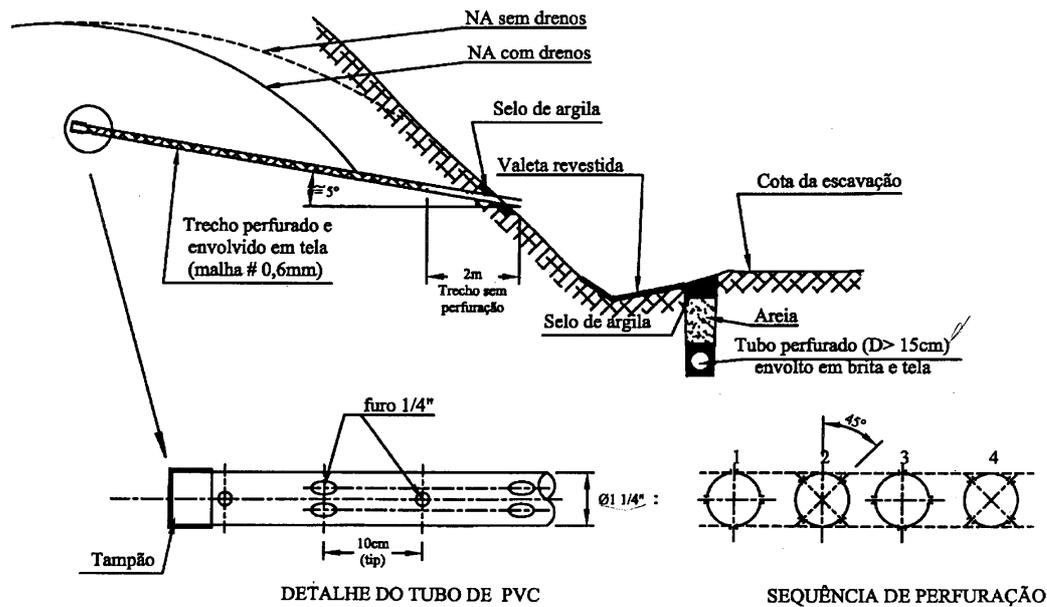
Detalhe instalação de drenos subhorizontais profundos (Alonso, 1999).
